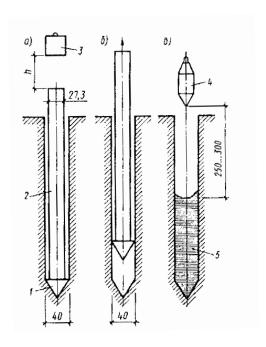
Схема устройства грунтовых свай способом сердечника:
